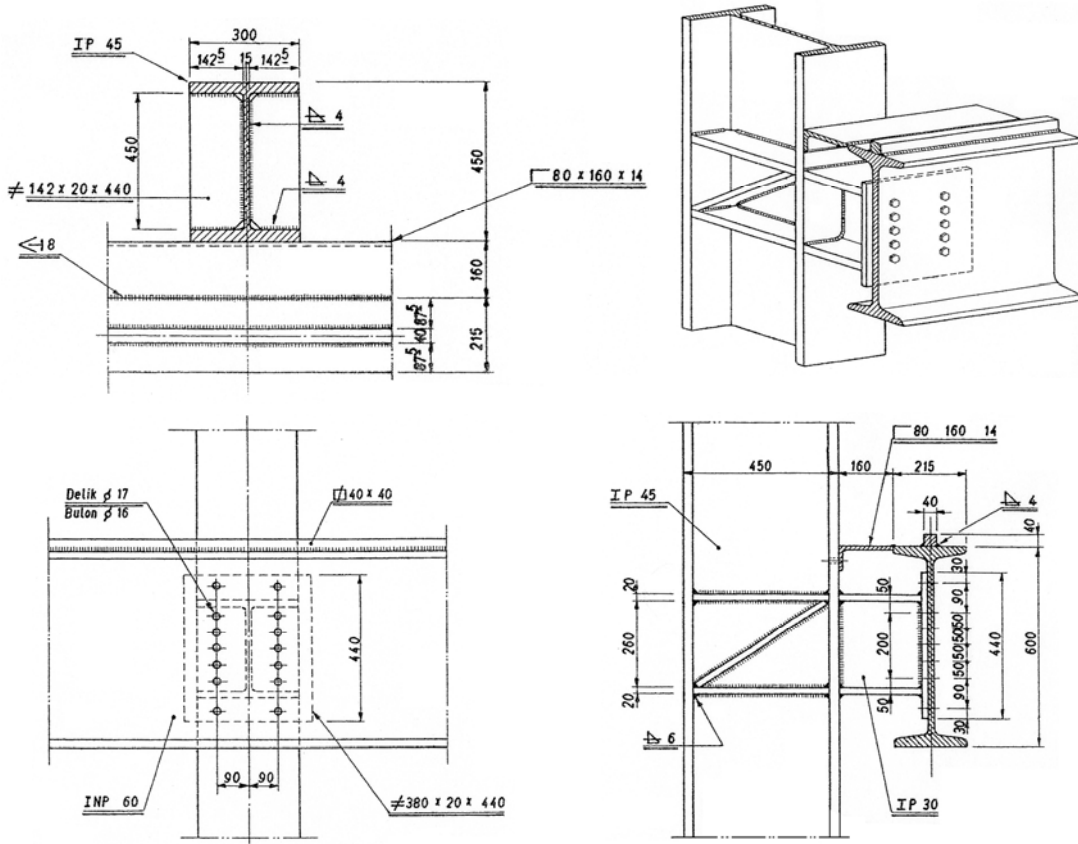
Çerçevenin kolon ile kiriş arasında rijit bağlantı detayı [35]
